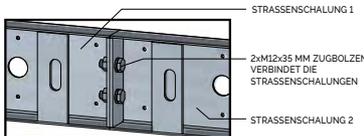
DETAILS ZUM AUFBAU STRASSENSCHALUNG
